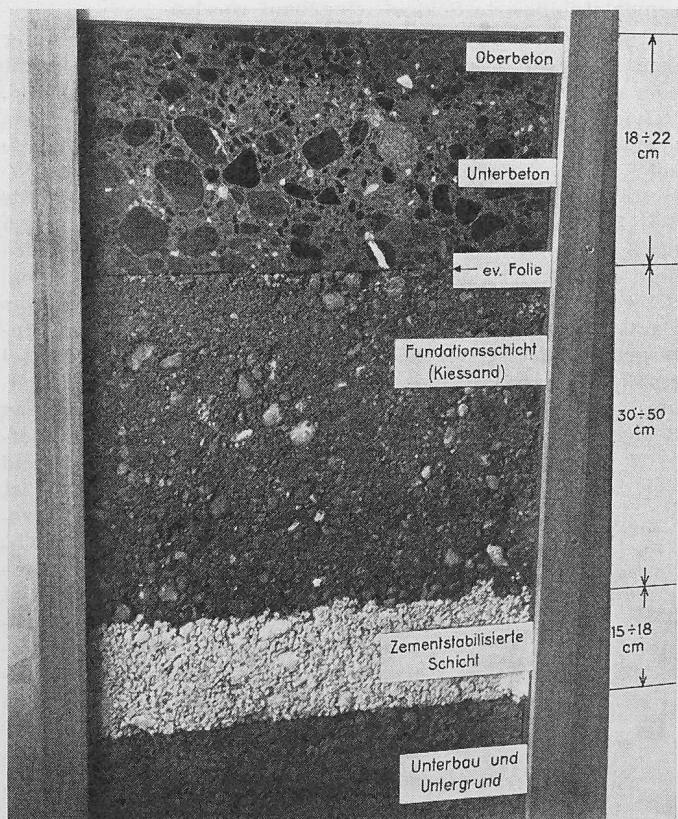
Aufbau einer Strasse mit Zementbeton-Belag und zementstabilisierter Uebergangsschicht (Trennschicht zwischen Untergrund und Fundationsschicht)
